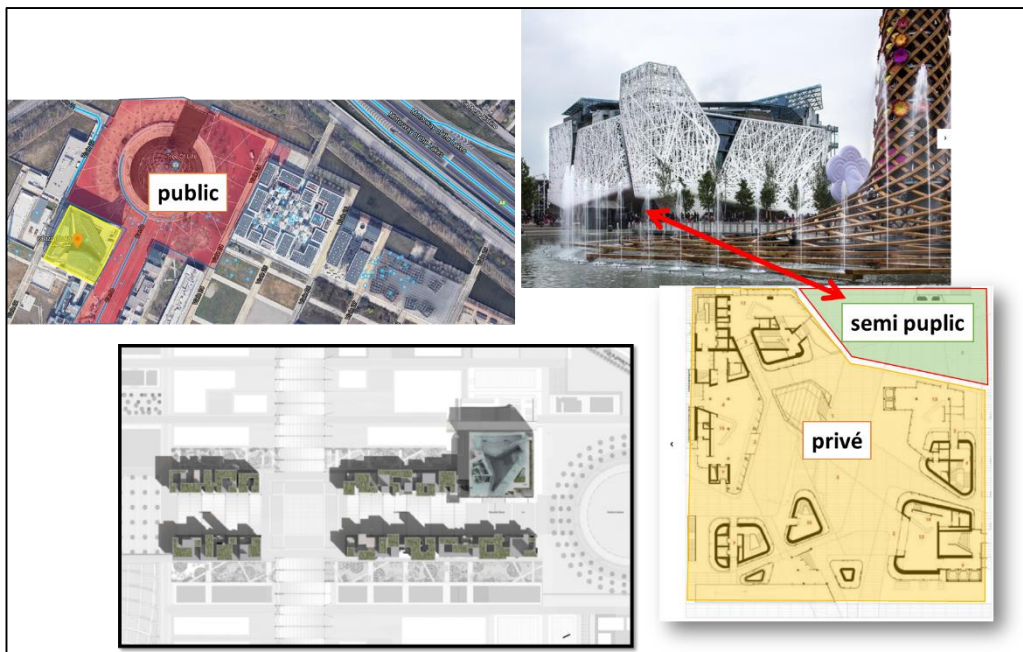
Hierarchie en plan de masse établi par auteur 2021
